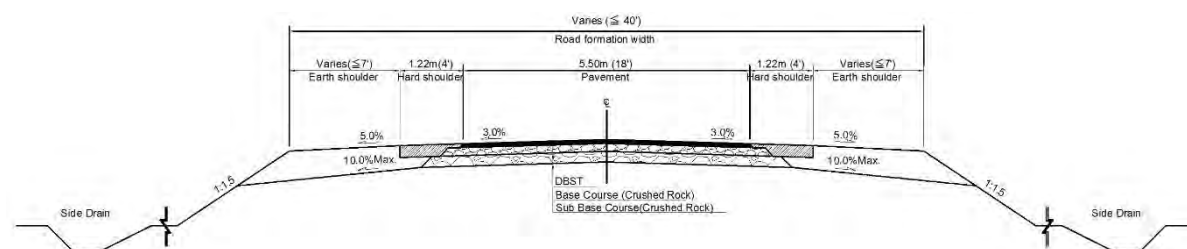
標準横断面図 (平地部/ MOC-07 : DBST オーバーレイ 5.5m)
